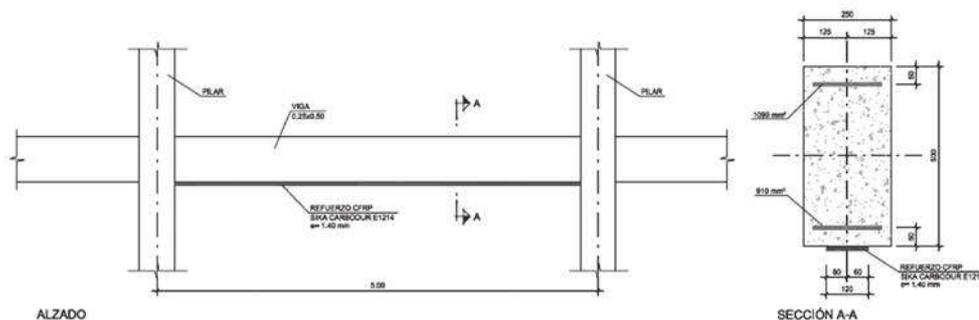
Refuerzo en vigas. Fuente: Acciona Ingeniería S.A.
